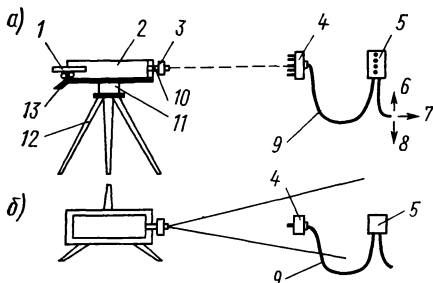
Схема одномерного управления строительными механизмами с помощью лазерного прибора:
